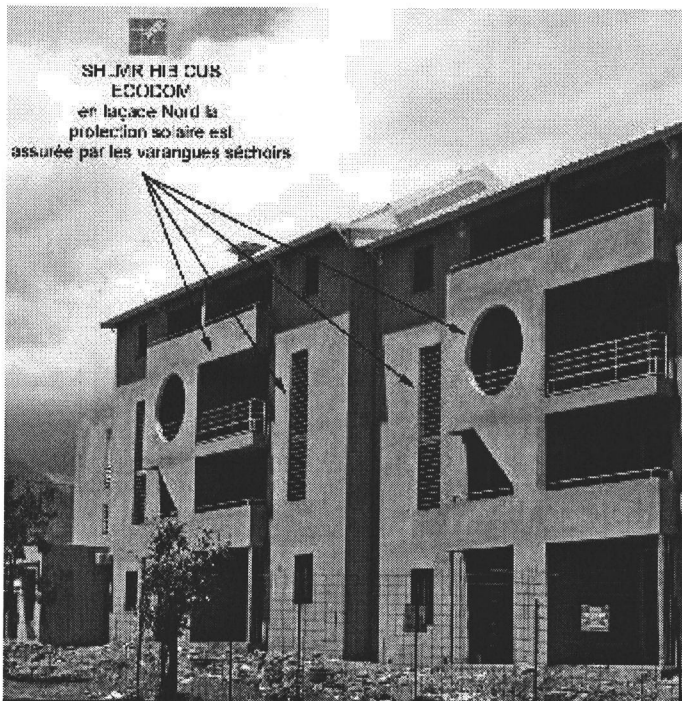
Façade Nord, Bâtiments D, E et F. La protection solaire des baies du séjour est assurée par les varangues qui servent d'espace tampon
